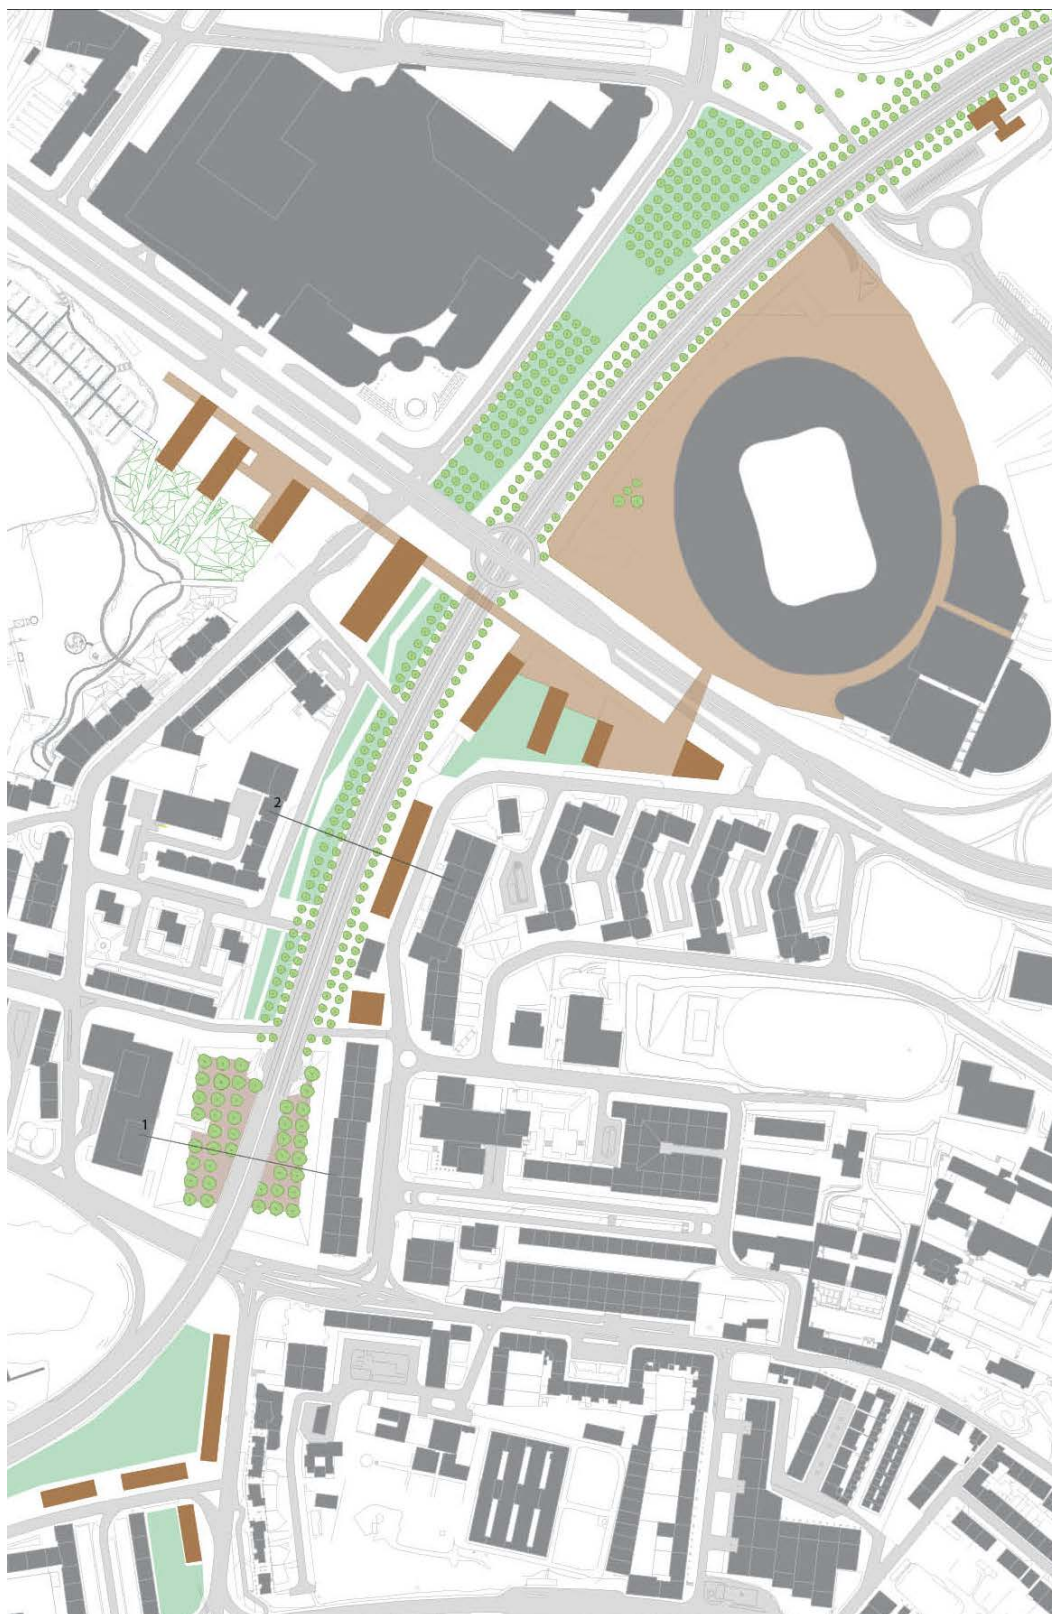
Planta do Eixo Luz/Benfica (Fonte: Autor)
